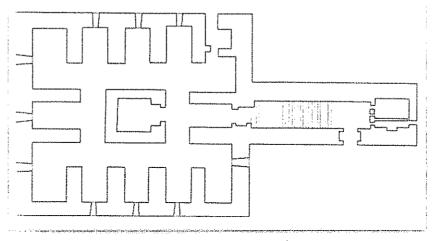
مسقط أفقي تخيلي لبوابة البرادعيين الموحدية، عمل الباحث.
